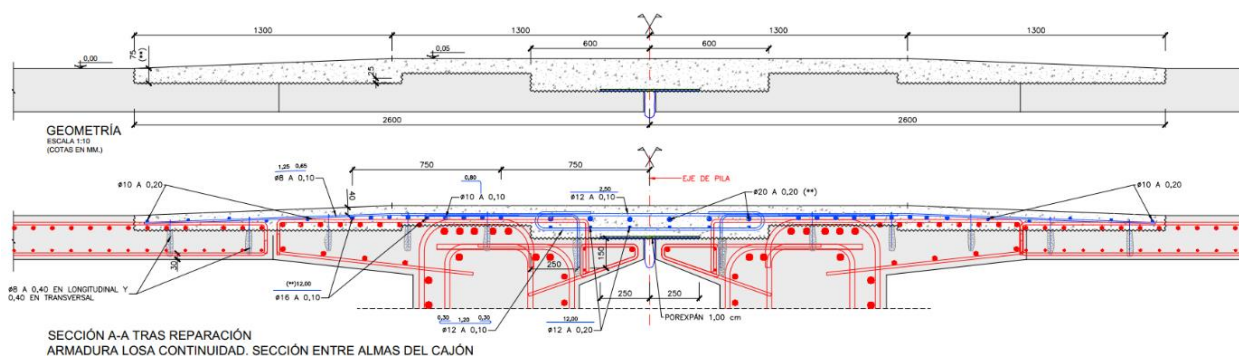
Detalle de la reconstrucción de la losa de continuidad. Geometría y armadura. (Fuente: [5]).
